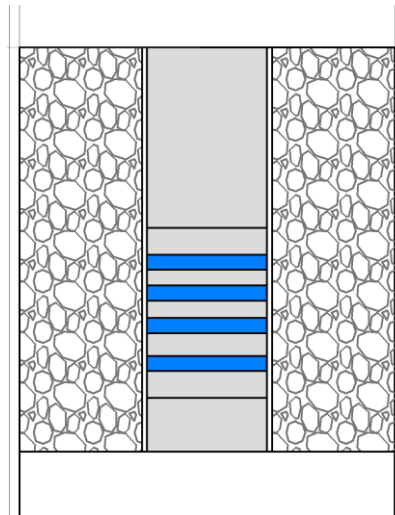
Esquema em planta do quebramar com o dispositivo integrado.
